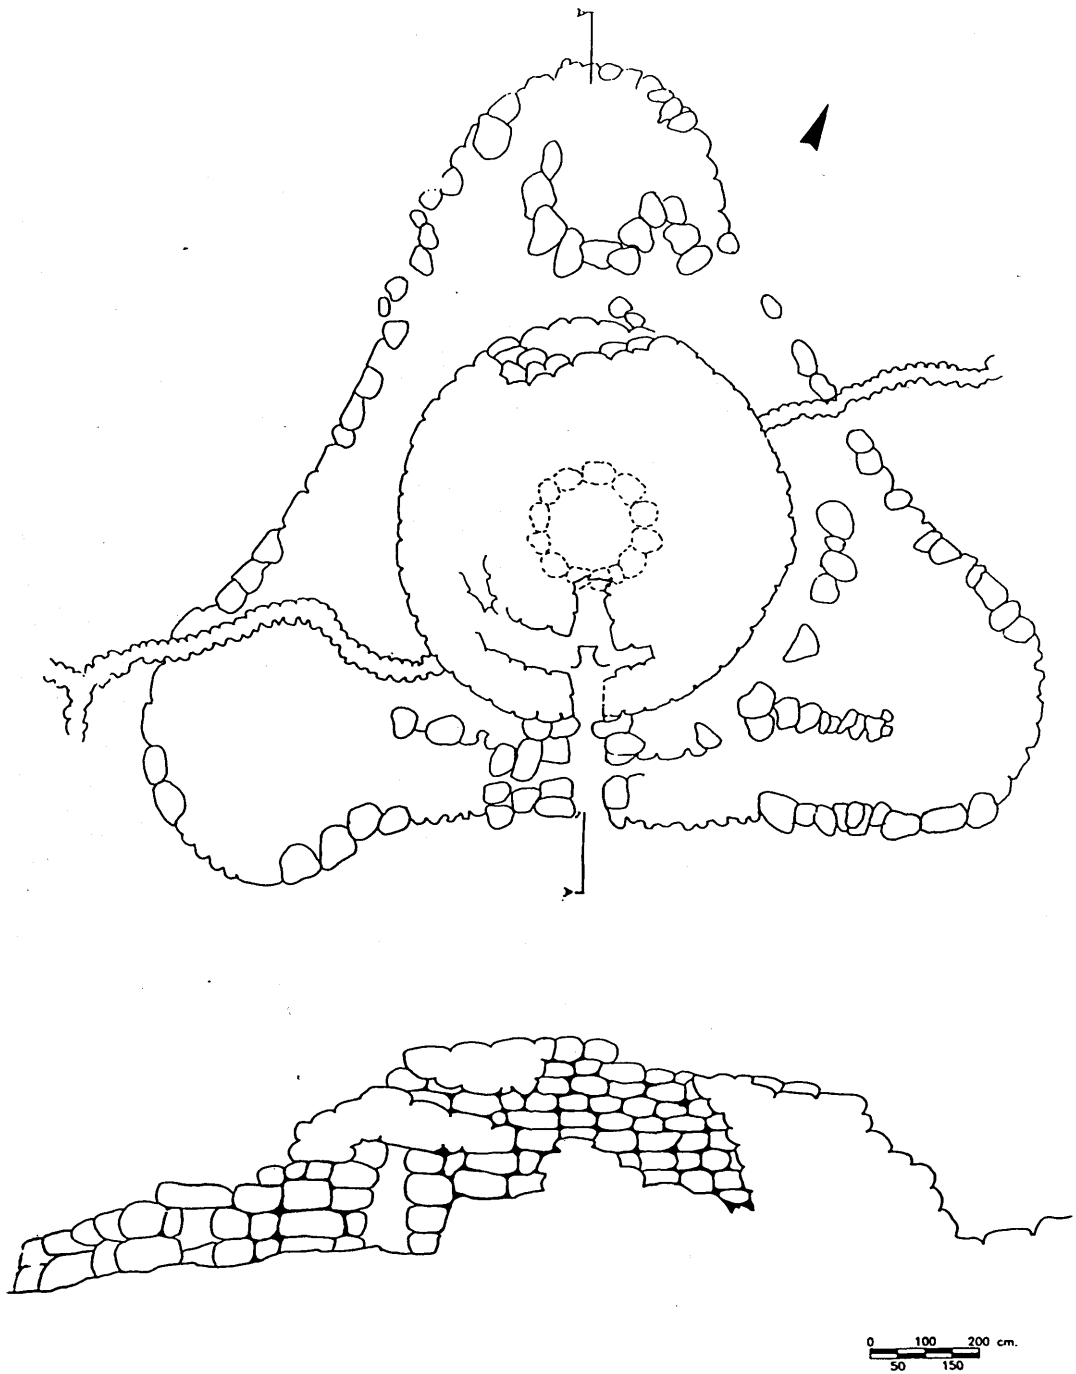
Nuraghe Montemajore: planimetria e sezione.
